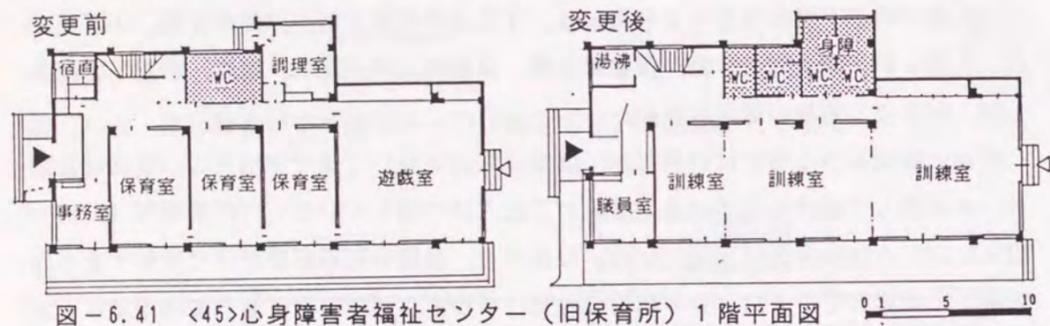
<45>心身障害者福祉センター(旧保育所)1階平面図
